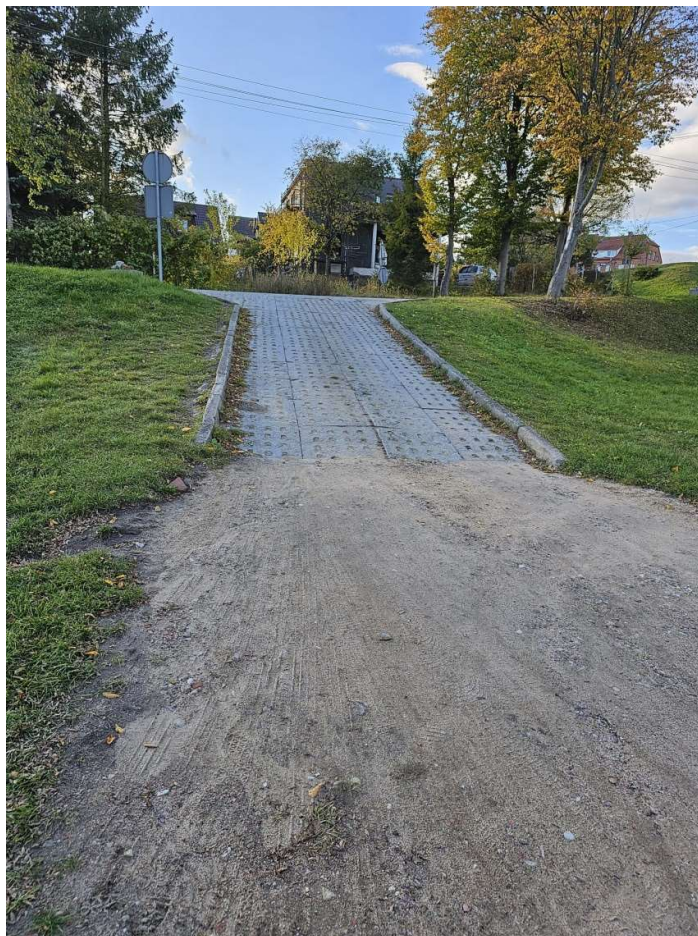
Dz. 214/5 widok na boisko piaskowe
